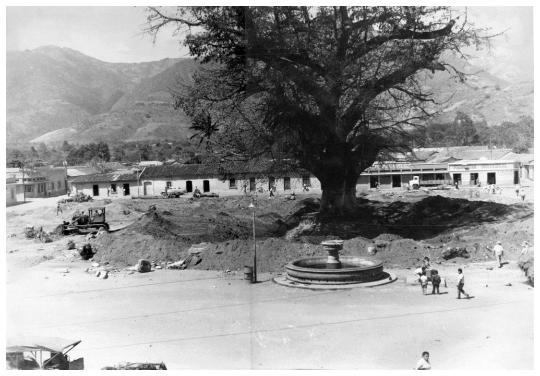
Derribo de la ceiba de la plaza central para dar paso a la construcción del parque central (Amatitlán 1967 aproximadamente) también se observa el estilo arquitectónico de las edificaciones ubicadas sobre la 3ª avenida entre 6ª y 7ª calle. Fuente: http://www.miamatitlan.com/amatitlaacuten-de-antantildeo.html (septiembre 2015)
